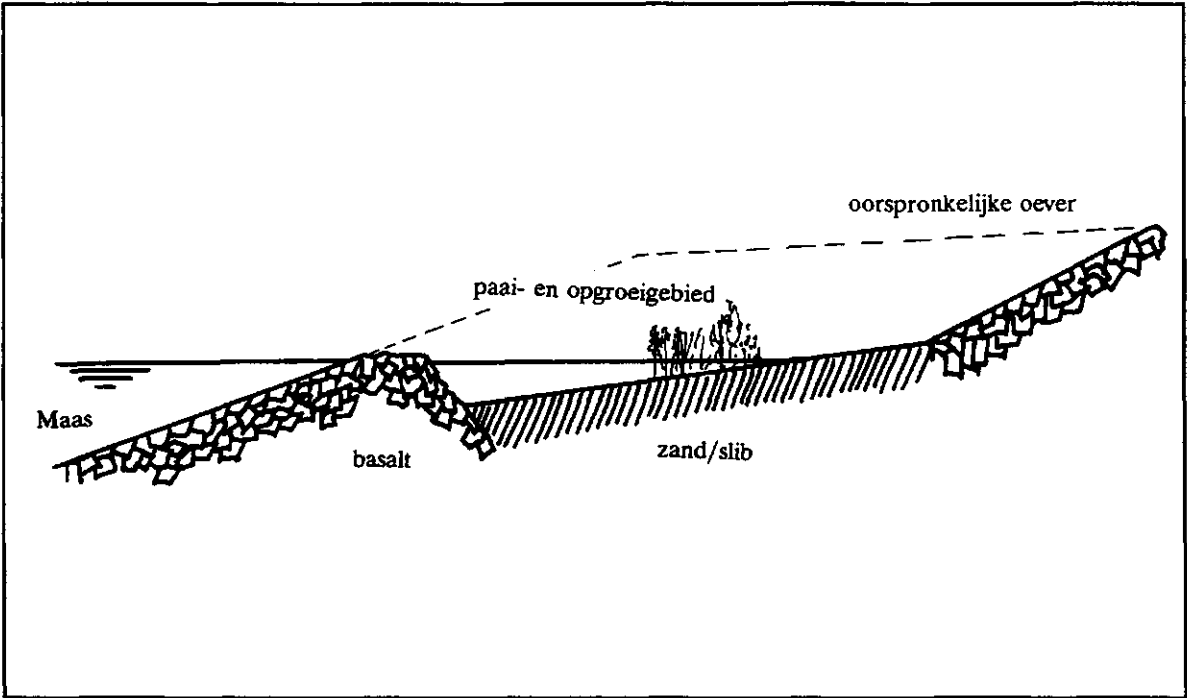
Zijaanzicht paai- en opgroeigebied type 2 (schaal 1:100)
